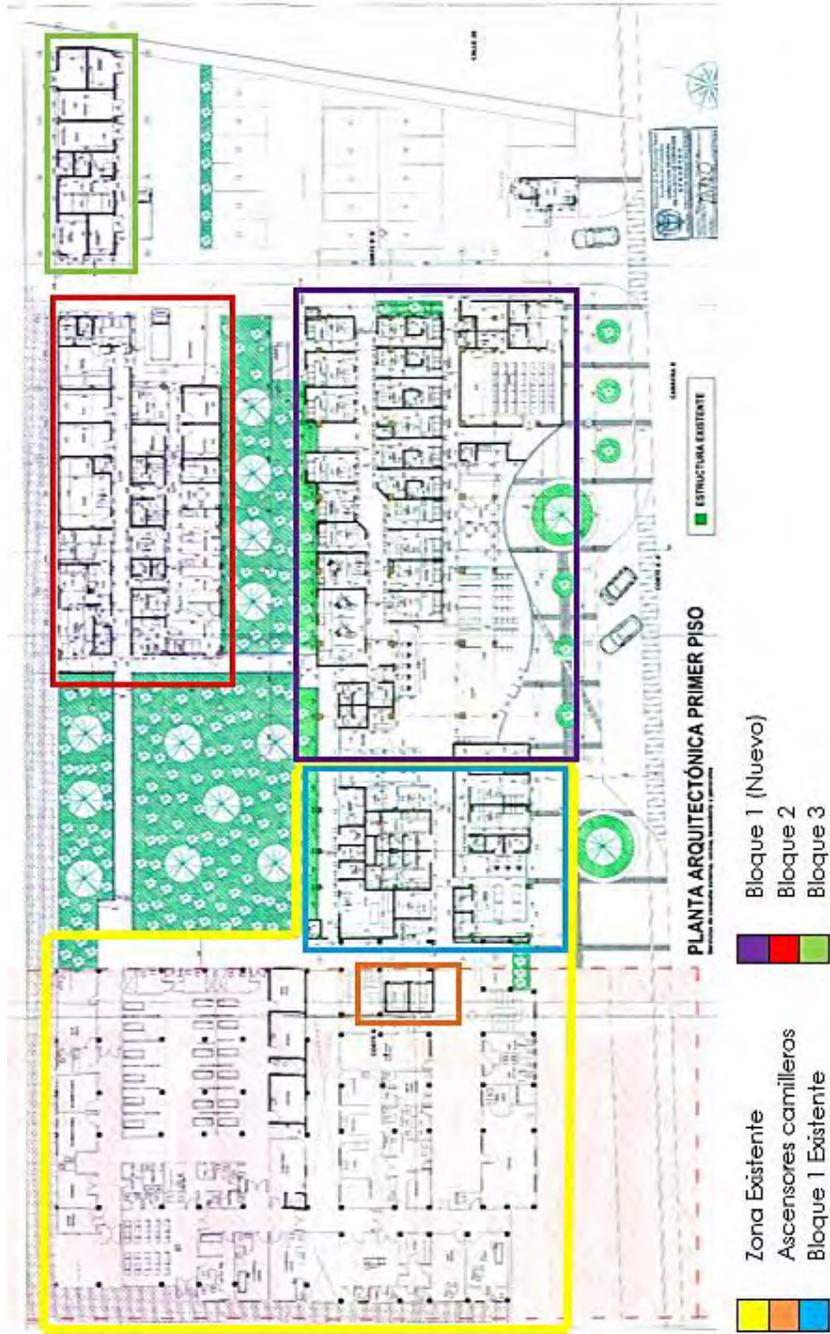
Esquema de ubicación de Bloques en plano arquitectónico.
